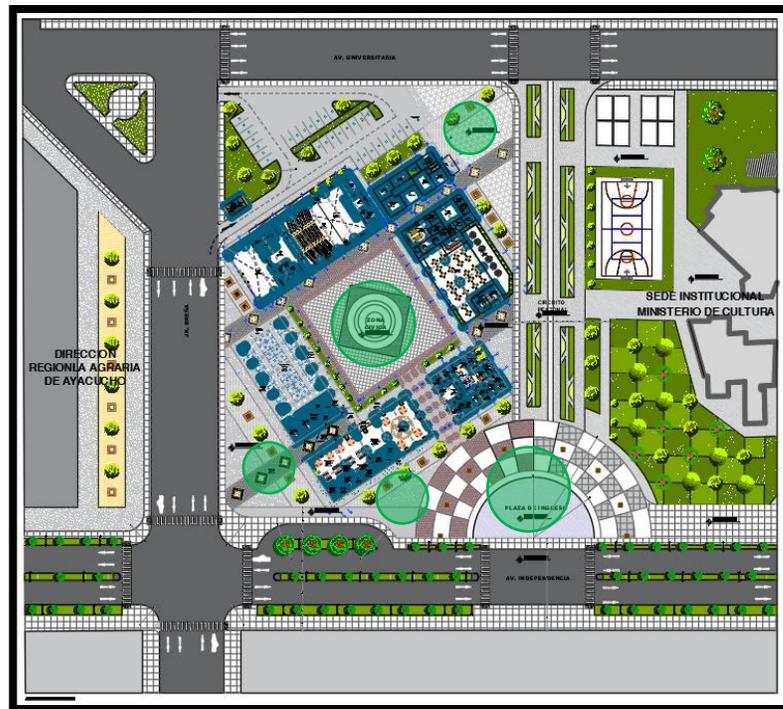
Planimetría General – Ubicación de Zonas Seguras.
